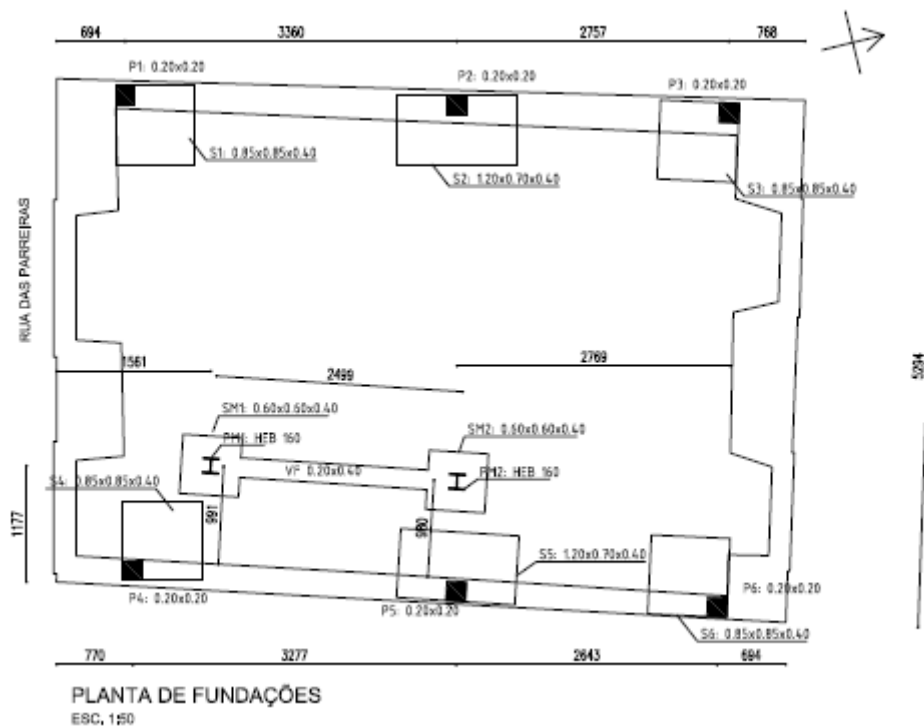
planta de fundações (Nunes, Projeto de fundações, 2016)
